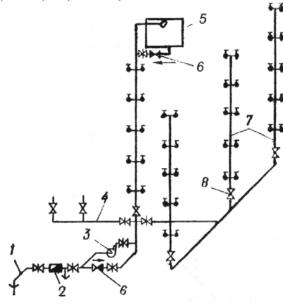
Система водоснабжения здания с водонапорным баком и повысительным насосом:
